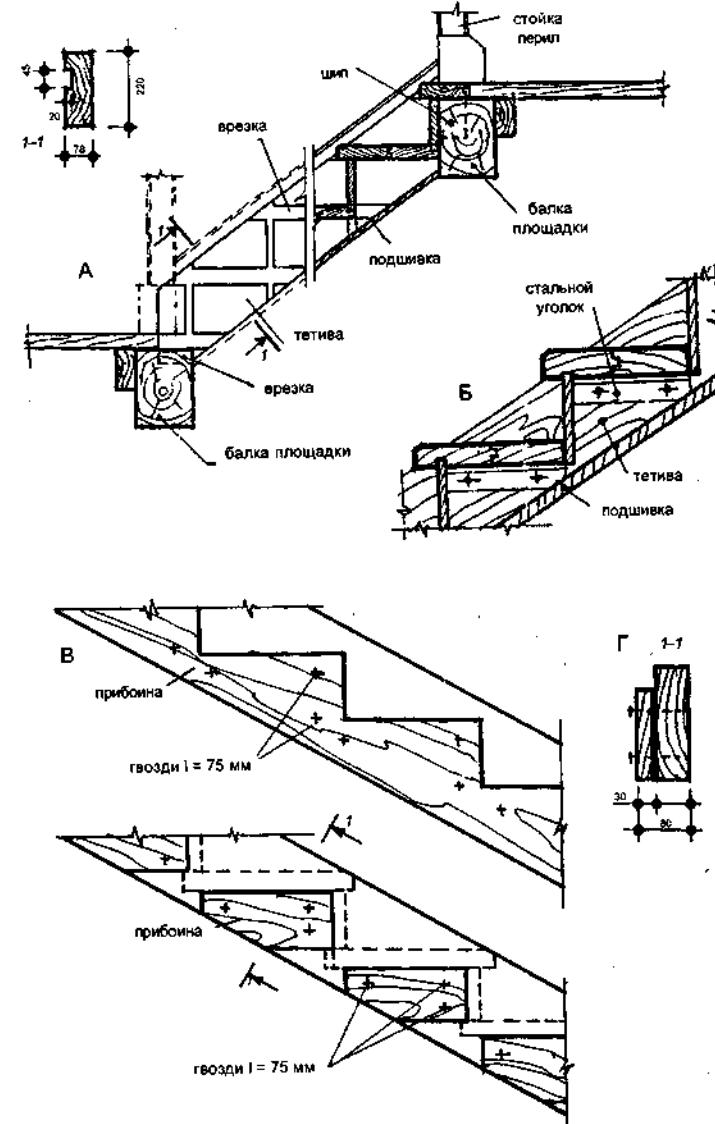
Конструкции деревянных лестниц на тетивах:
